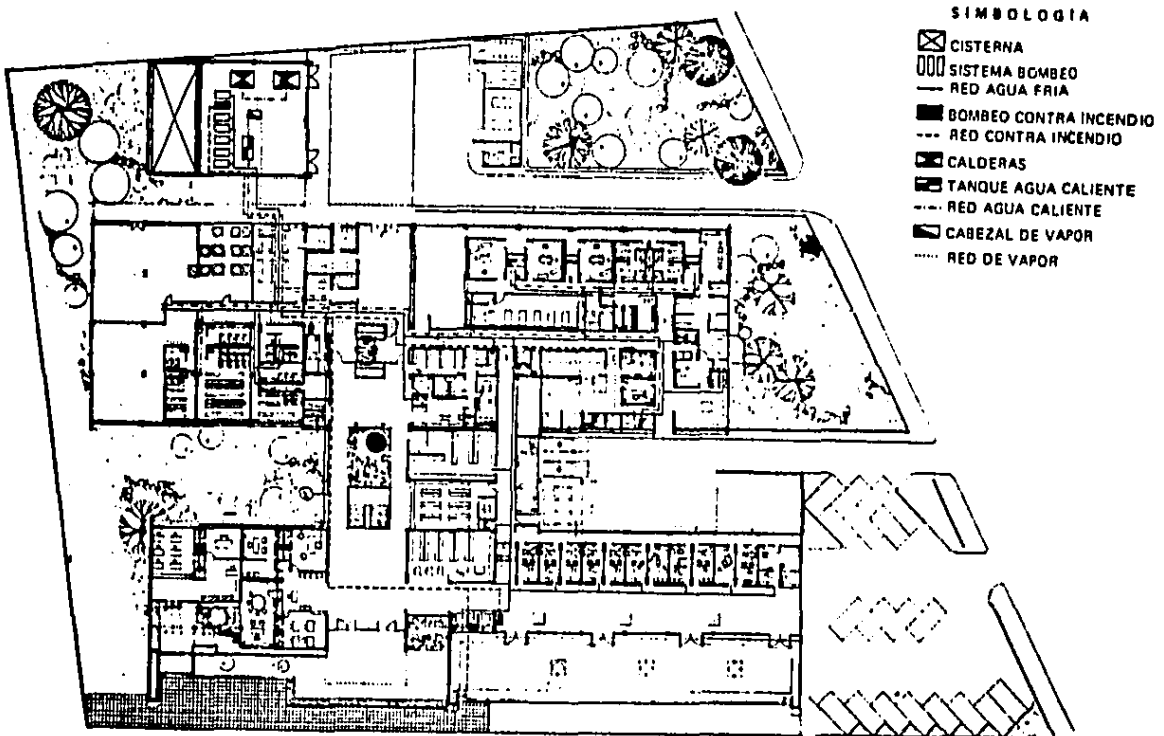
Planta Arquitectónica de Hospital General de Zona con Instalación Hidráulica y Sanitaria.
